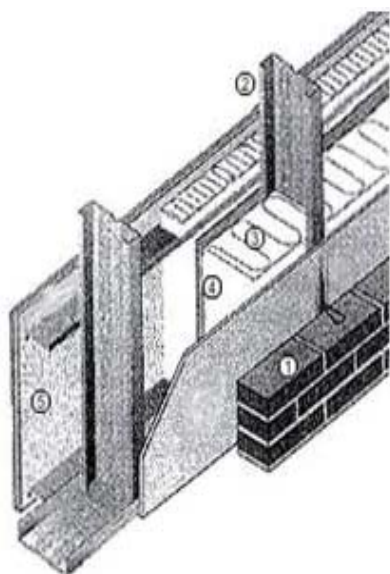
Конструкция наружной стены здания с каркасом из ЛСТК: 1 – наружная облицовка; 2 – перфорированный профиль; 3 – утеплитель; 4 – пароизоляция; 5 – внутренняя облицовка.
